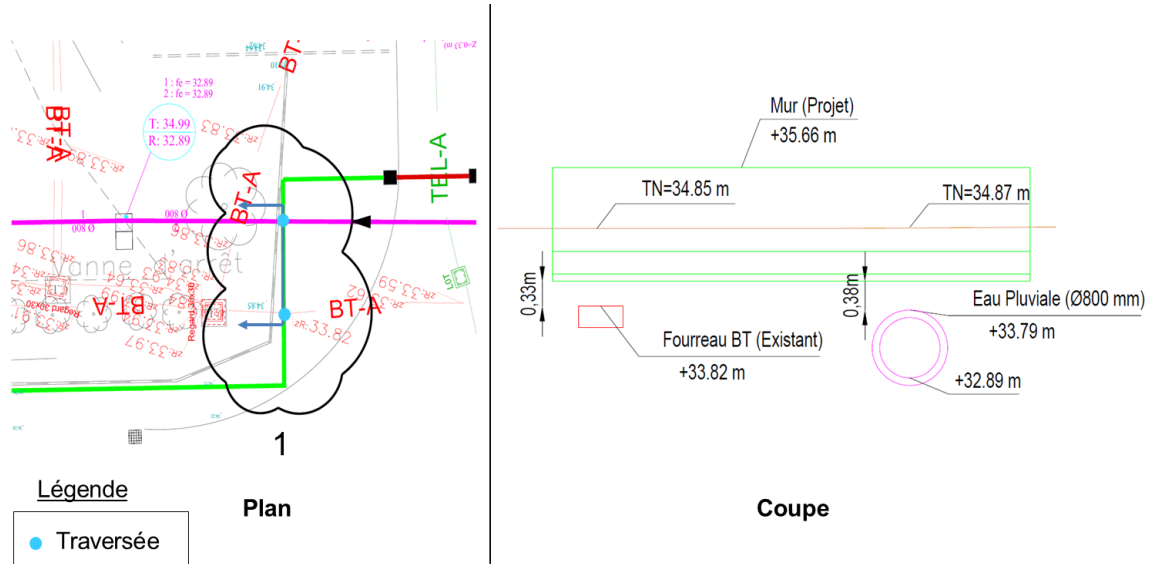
Mur traversant le fourreau électrique basse tension et la conduite EP
